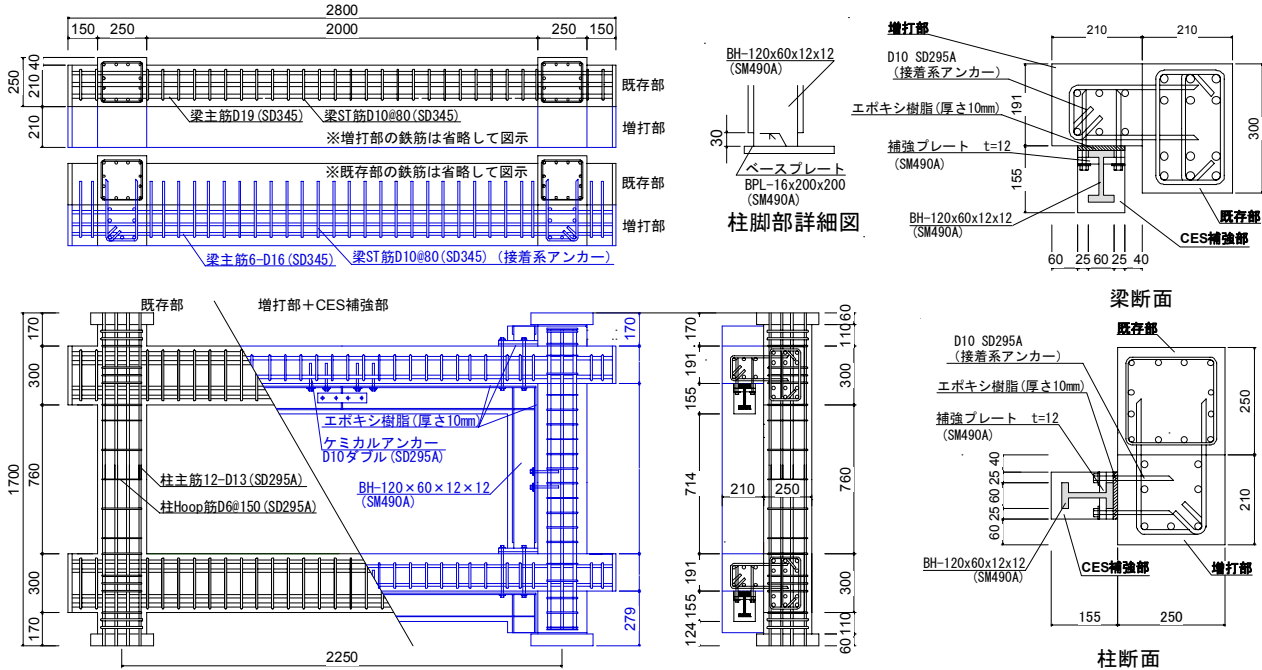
配筋図 : 試験体 ERF-B (既存部および CES 補強部は全試験体共通)
